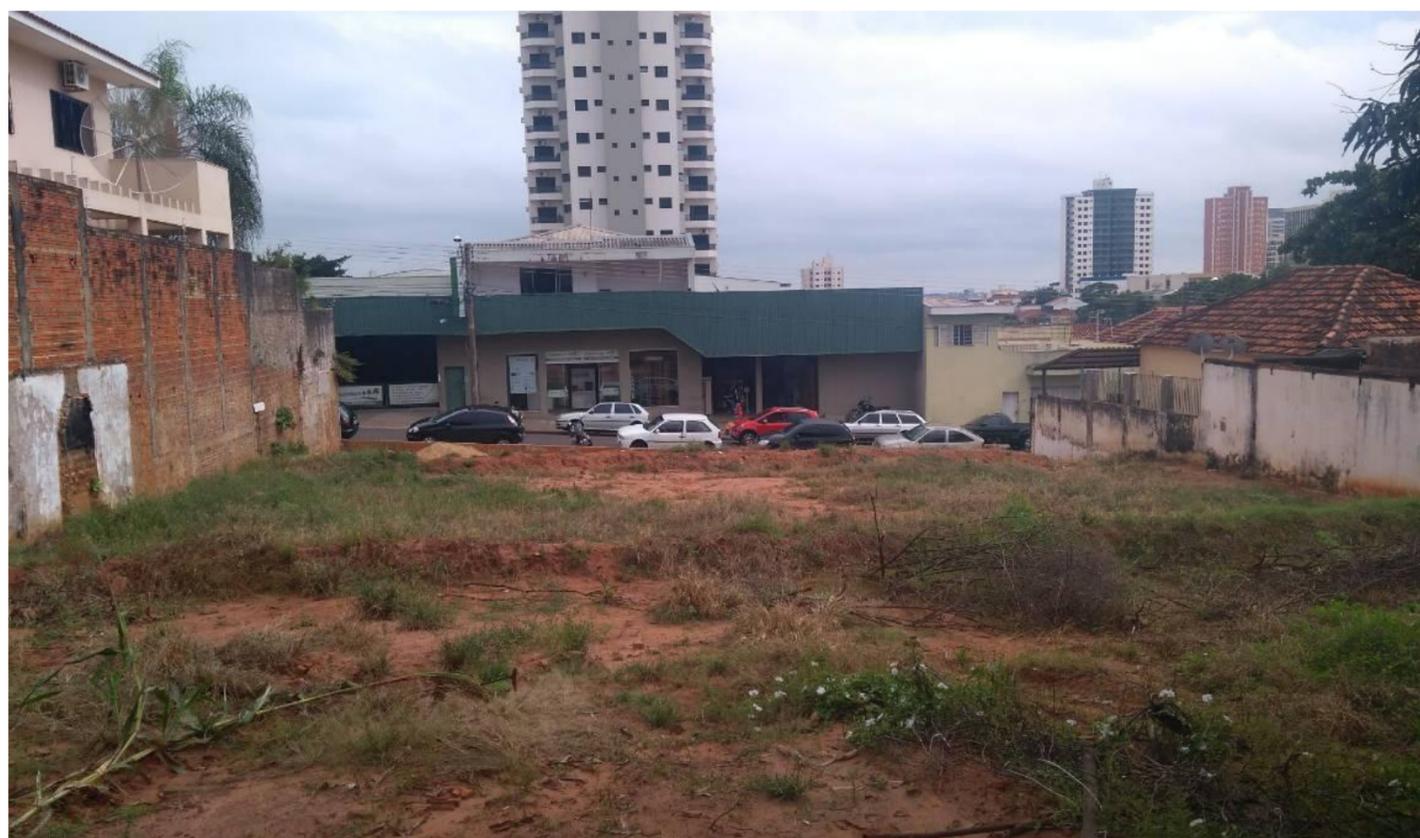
Vista do ponto mais alto do terreno, onde é possível observar o entorno, com construções térreas e verticalizadas.
